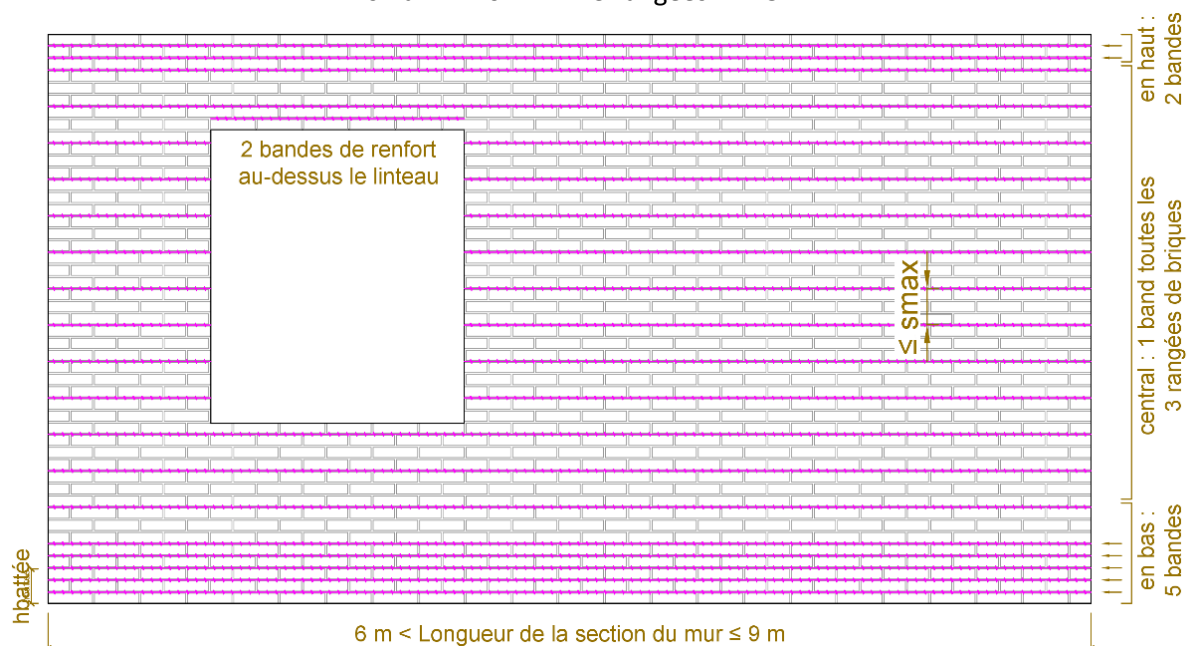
Exemple d'un plan calepinage des renforts de maçonnerie pour des sections du mur > 6 m
